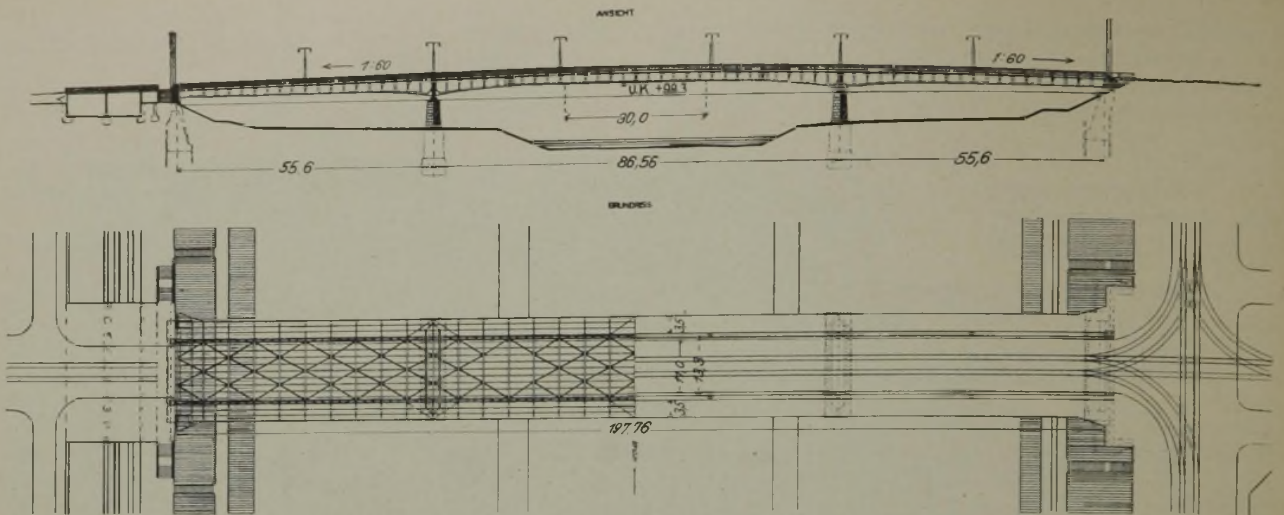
u. b. Ansicht und Grundriß der Brücke. (Maßstab rd. 1 : 1600.)
